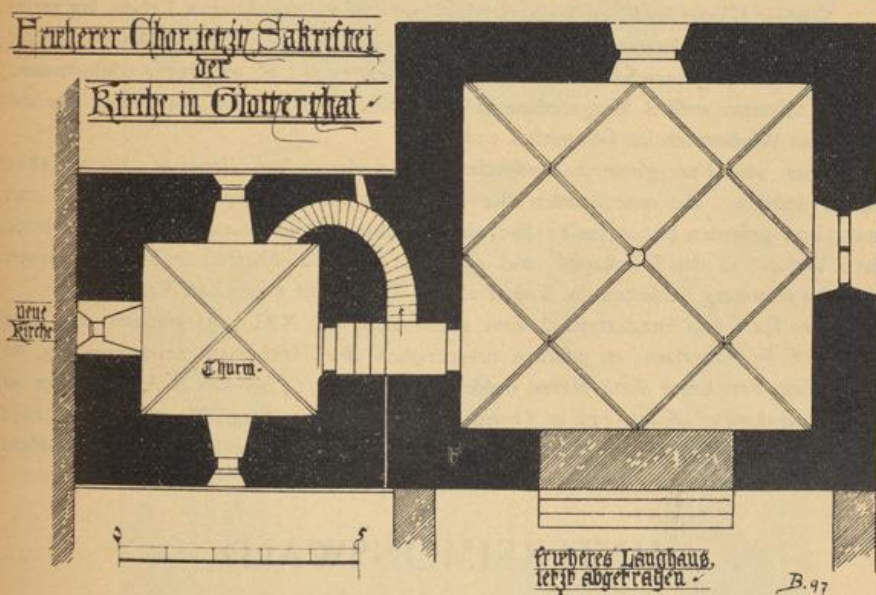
Unterglotterthal. Pfarrkirche, Grundriss des ehemaligen Chors und Thurmes.
